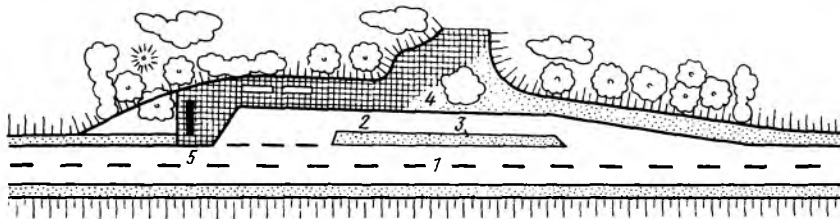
Планировка стоянки у маршрутной схемы:
